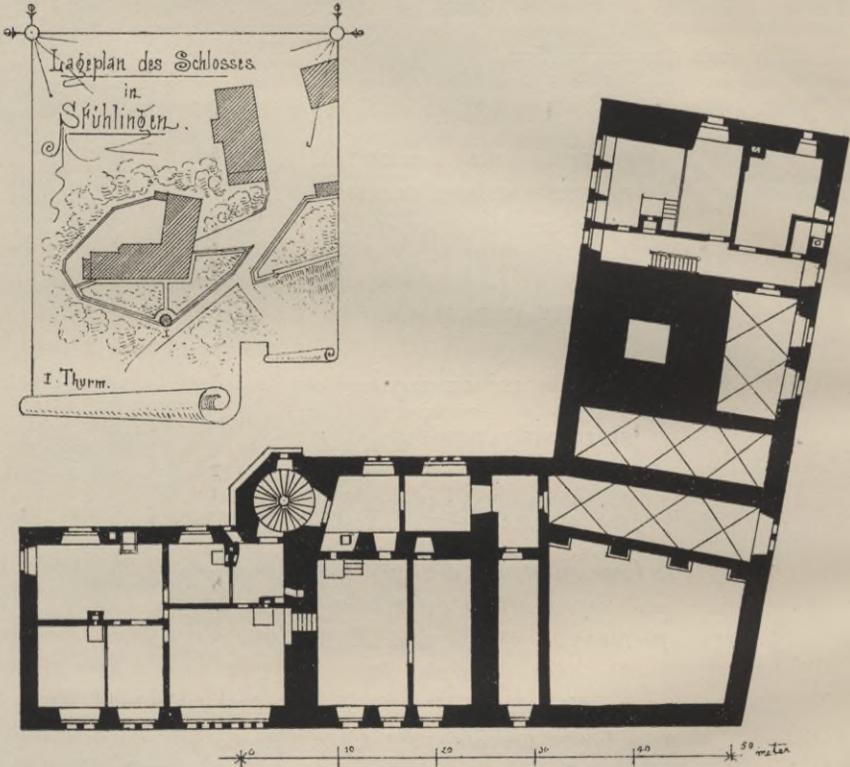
Stühlingen. Grund- und Lageplan des Schlosses.
